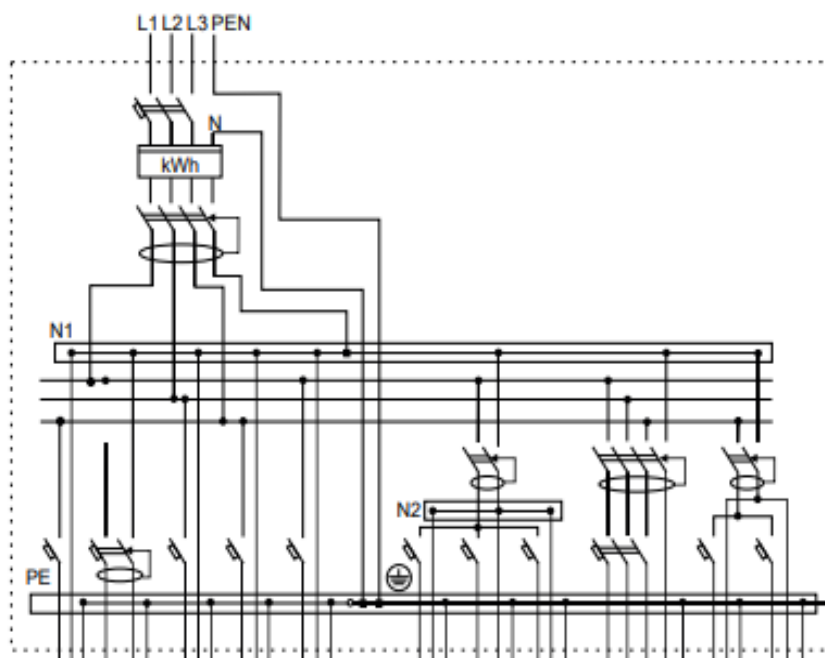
Схема квартирного учетно-группового щитка (для коттеджа)
